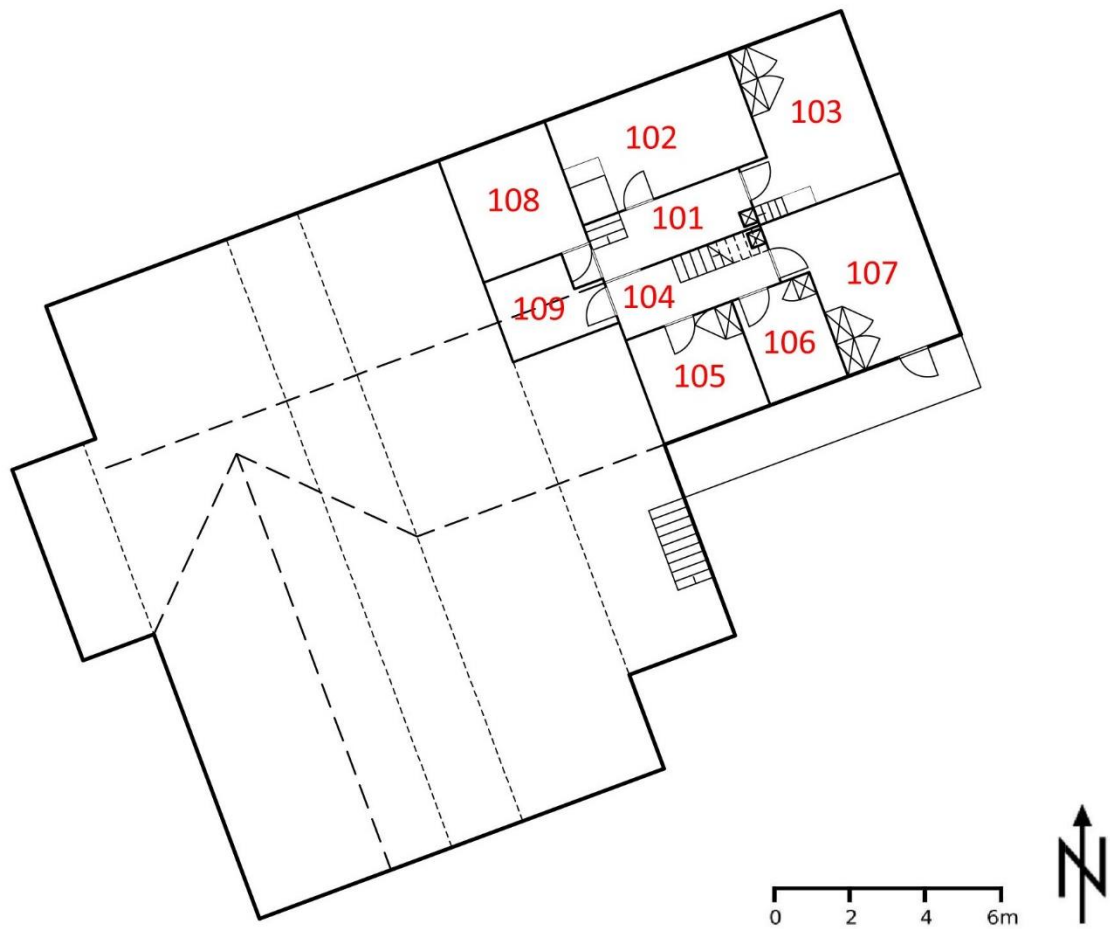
Schematischer Grundriss des Obergeschosses.
